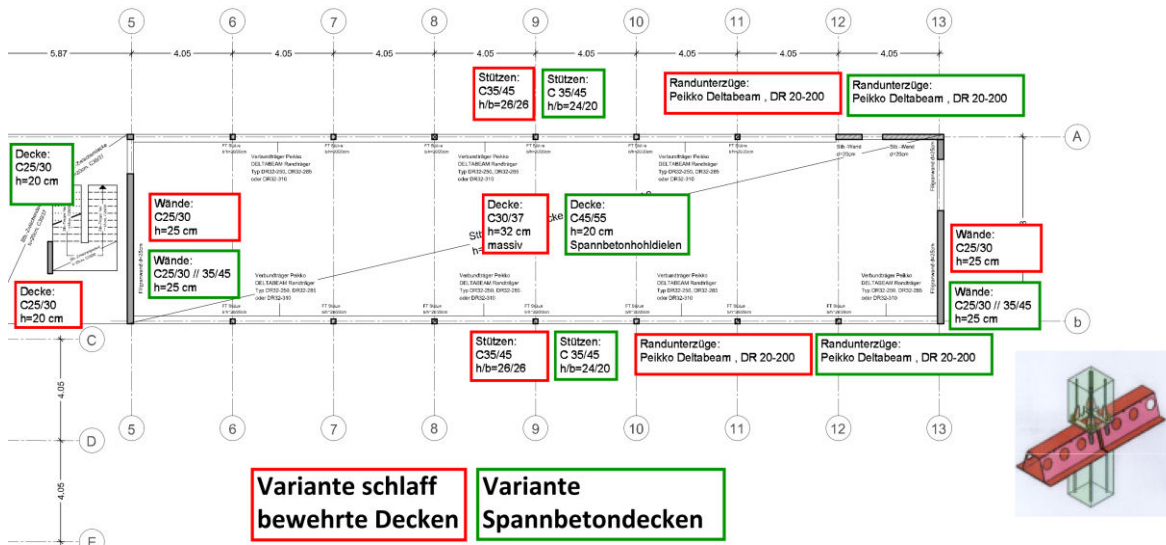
Bauteildimensionen (hier: EG, Decke über EG – horizontaler Flügel)
